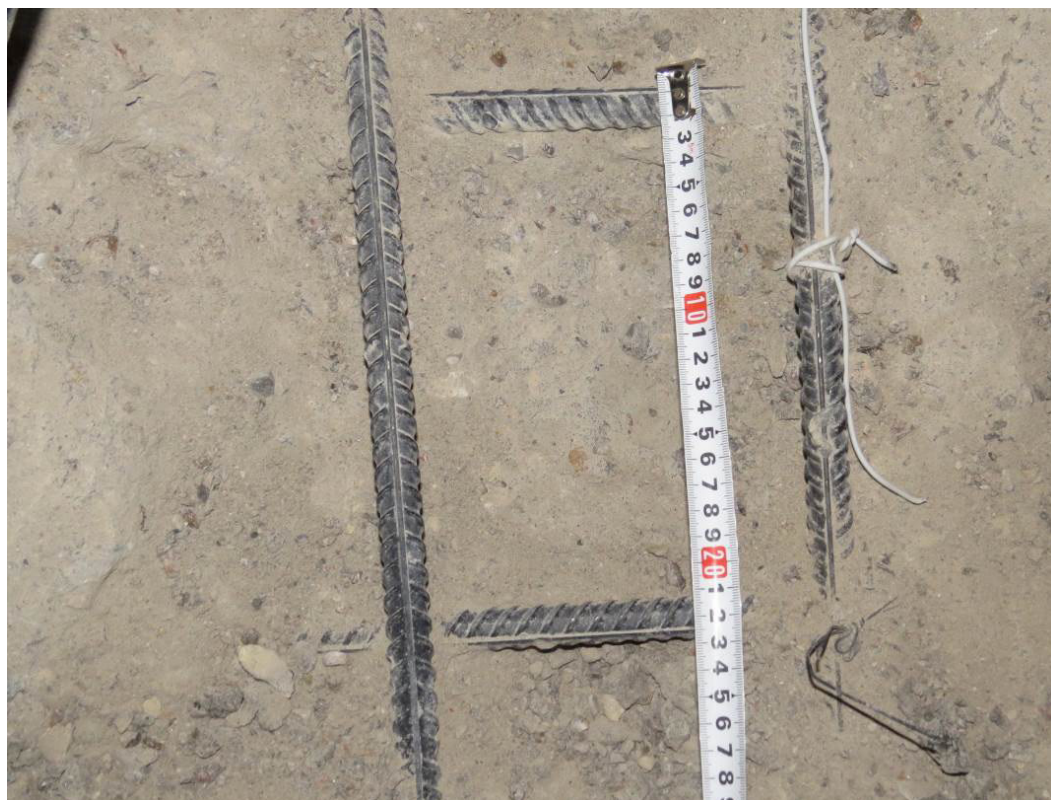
Замер шага вдоль буквенных осей верхней зоны армирования фундаментной плиты на участке вскрытия в секции 3 между осями 23-24 / А-Б
